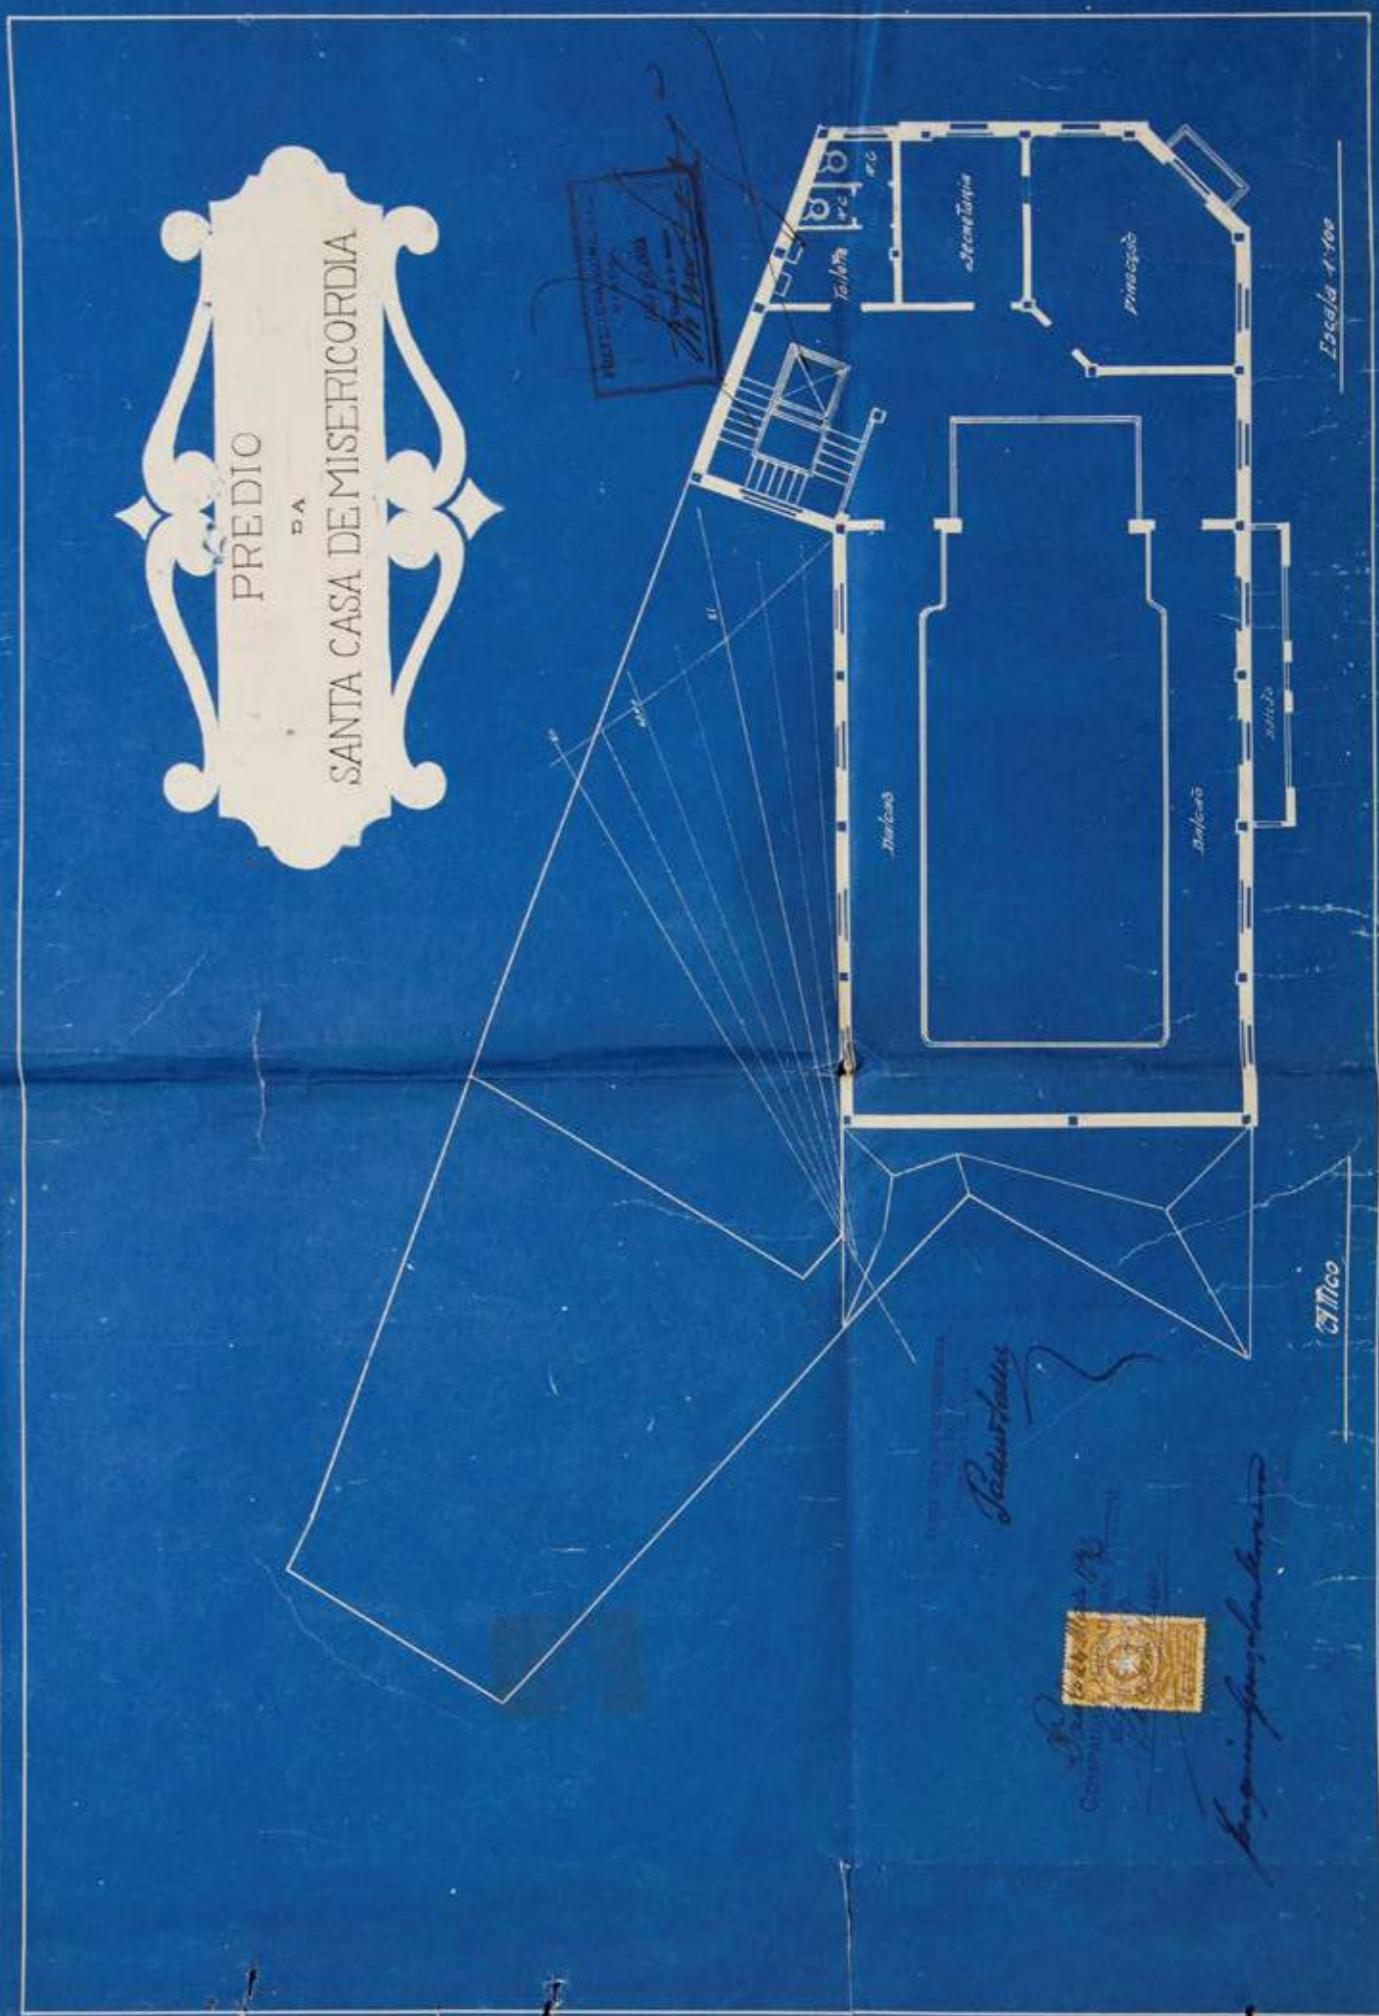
Planta do 5o pavimento (2o andar), 1923. Fonte: Arquivo Histórico de São Paulo.
